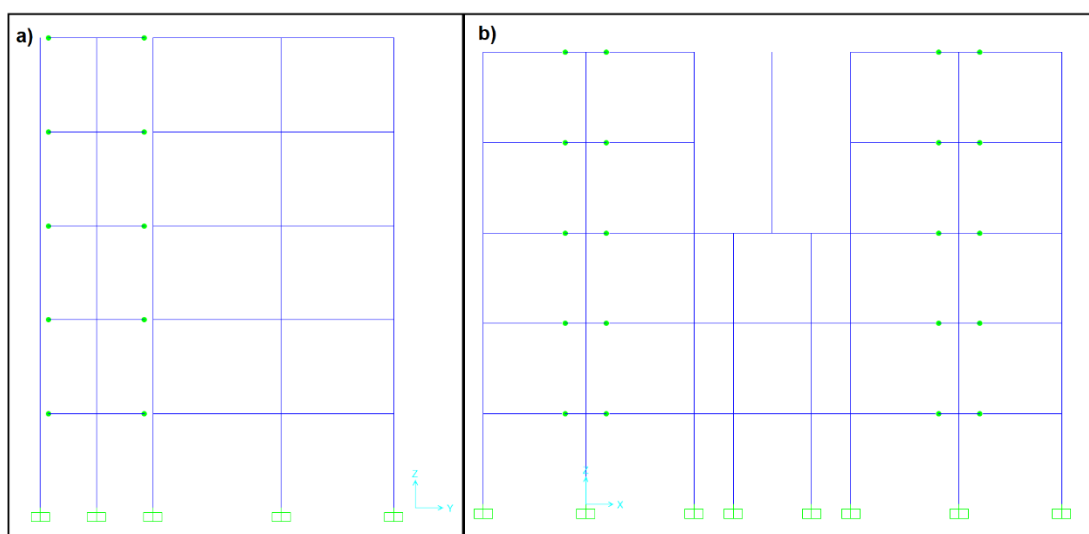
Detalhe de discretização de modelação com as rótulas. a) Pórtico AY/IY, paredes PY1 e PY2; b) Pórtico 1X, paredes PX1 e PX2.
